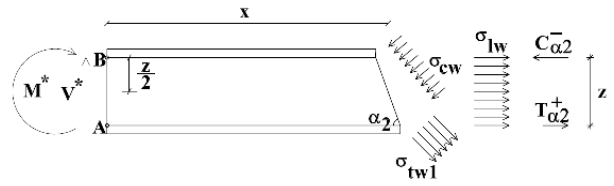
Tronco di trave, sezionato all'estremità con piano parallelo alla direzione delle staffe α_2
